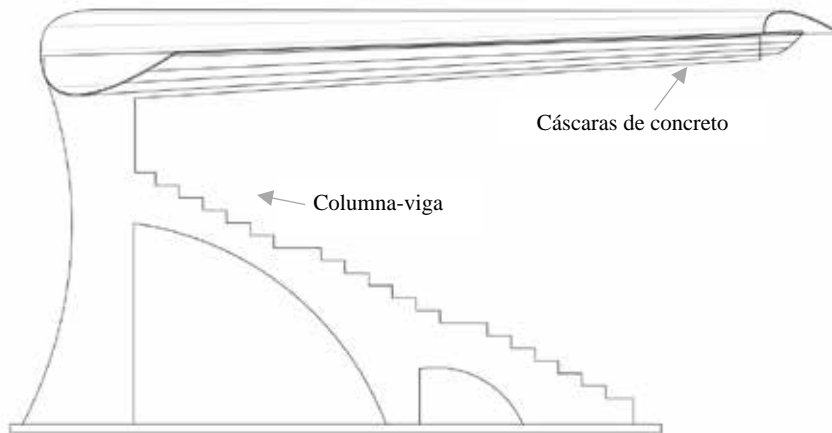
Vista lateral de columna-viga y cáscaras de concreto. La Autora (2020)
